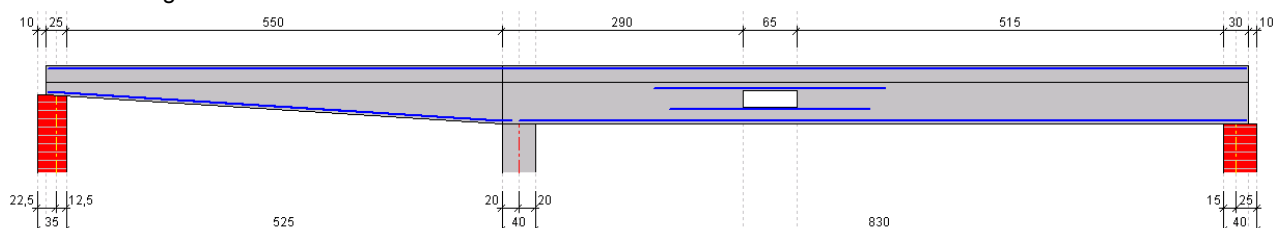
Ansicht des Unterzugs mit konstruierter Längsbewehrung
